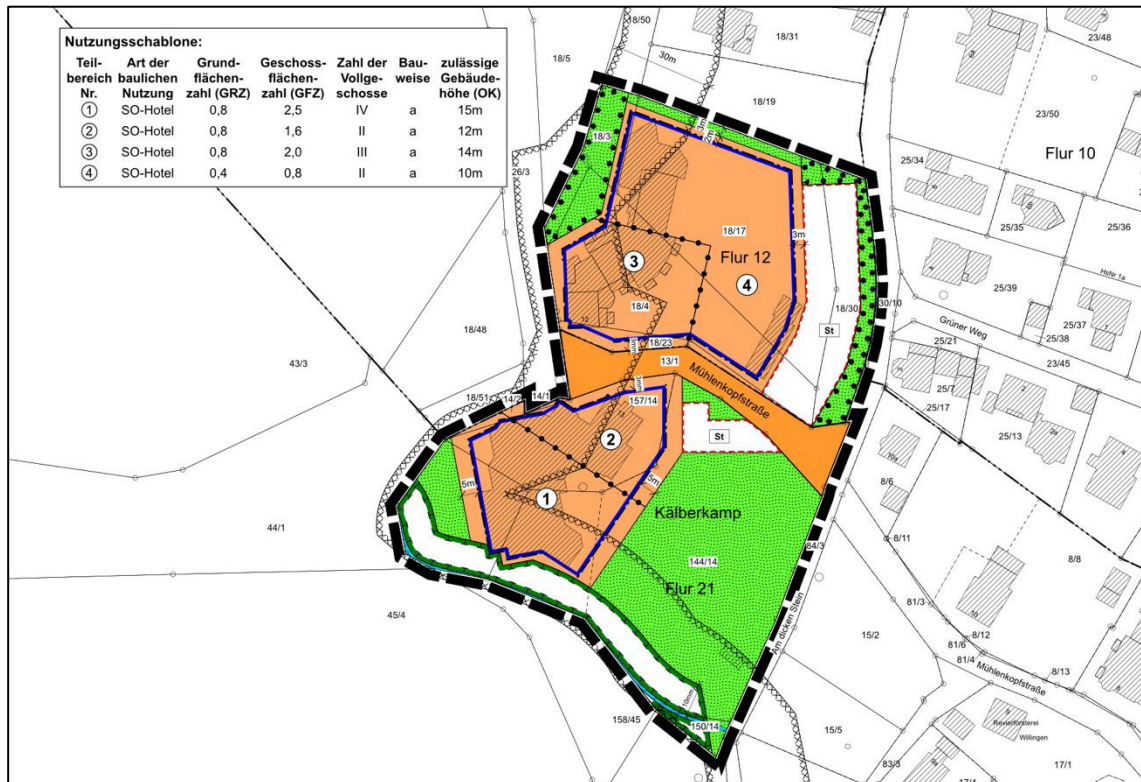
Bebauungsplan – Planteil (unmaßstäblich)
